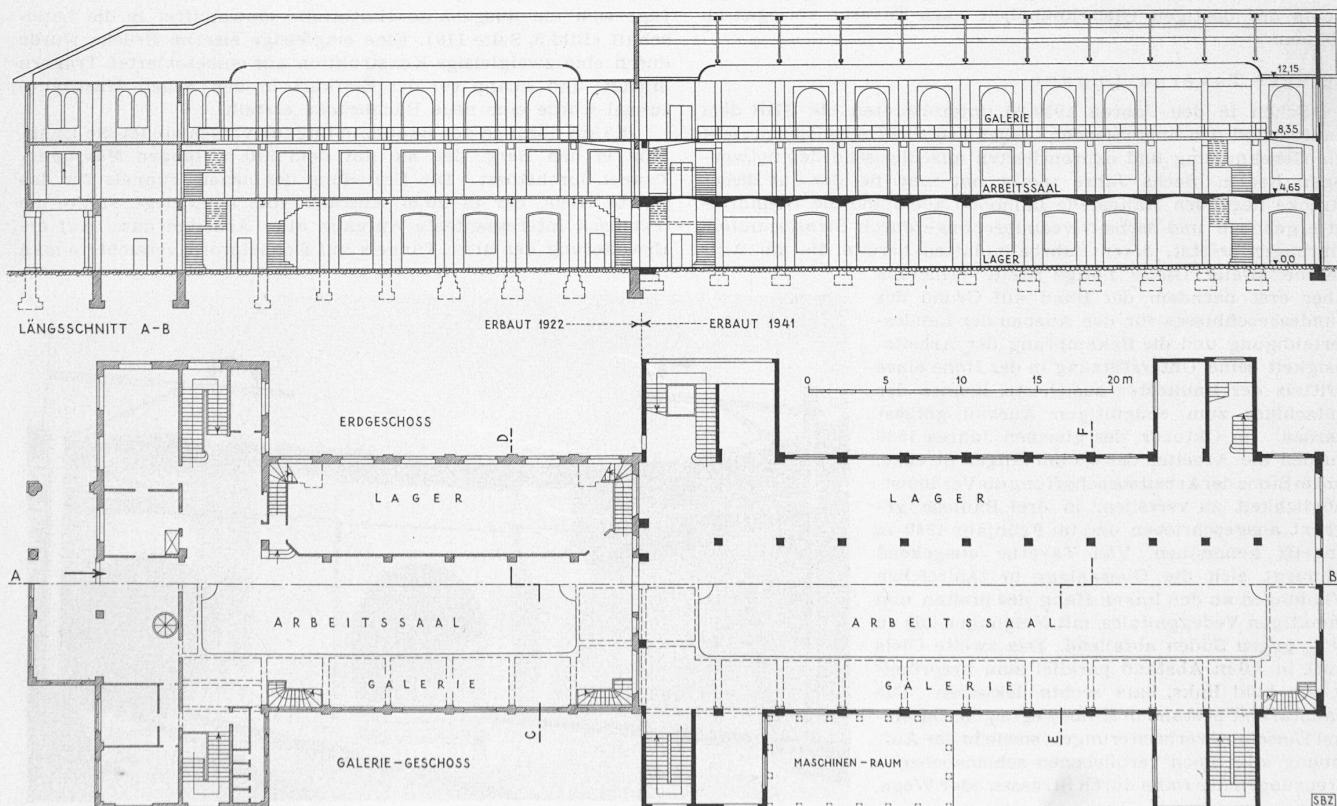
e 7. Stabilimento Pietro Realini S. A. in Stabio; pianta e sezione longitudinale 1:450
